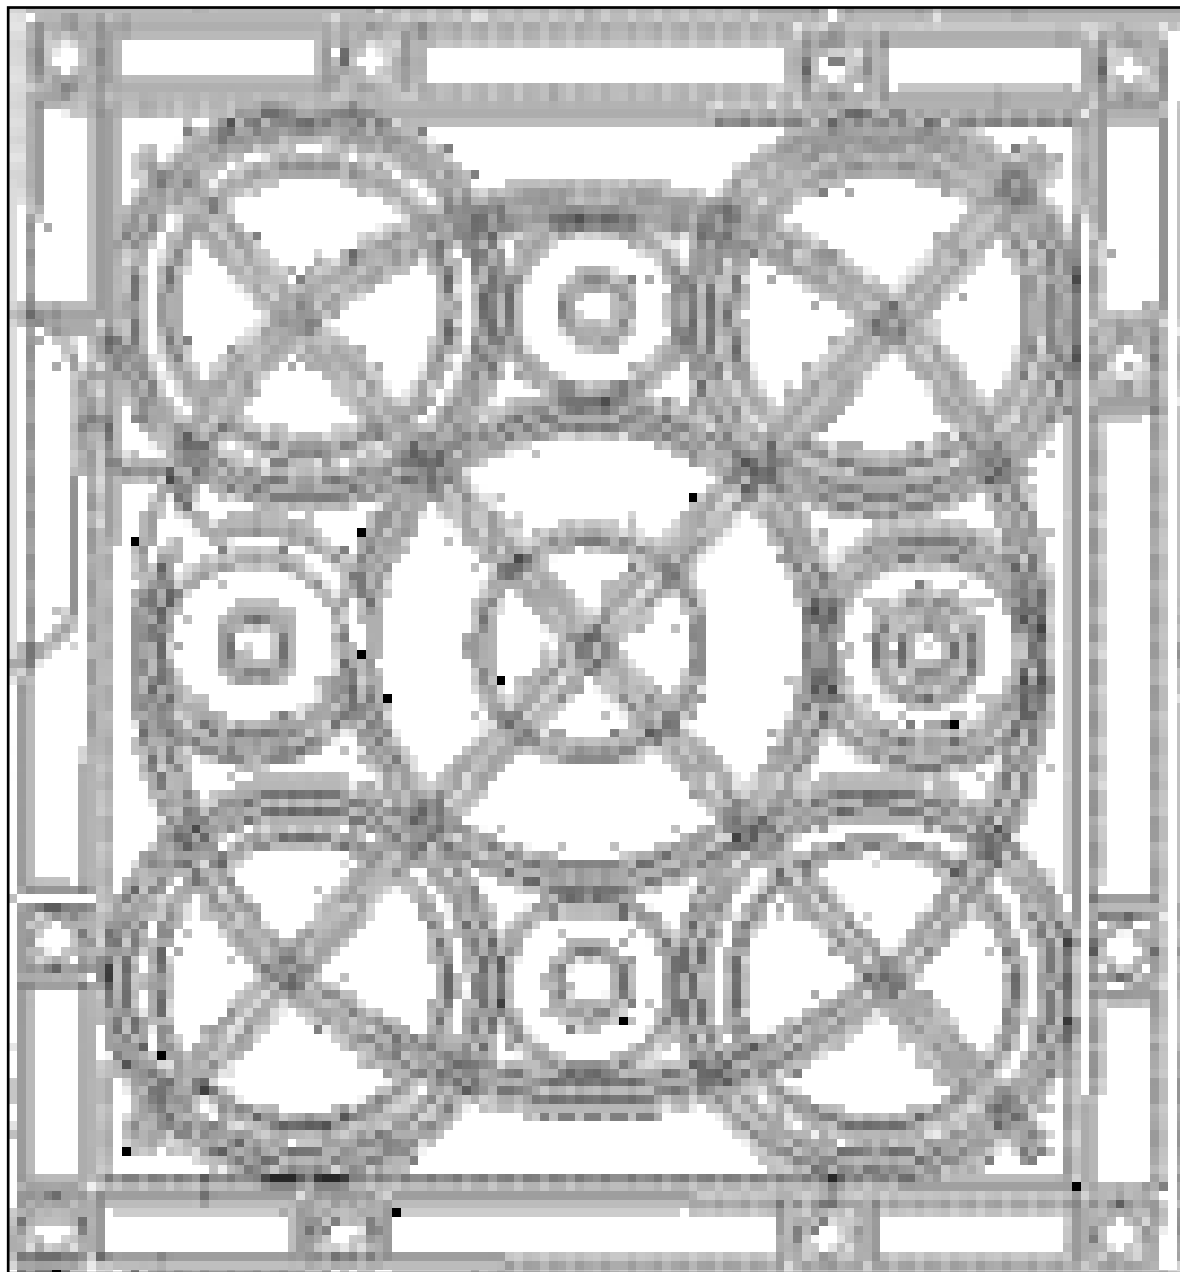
Pavimento sotto la cupola di San Giovanni. Dal rilievo fotogrammetrico del pavimento.
